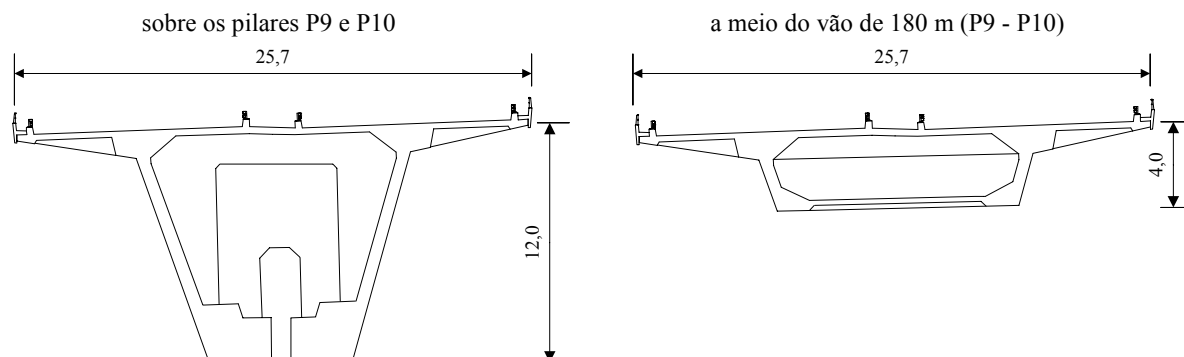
Secções transversais do tabuleiro da ponte Miguel Torga.
